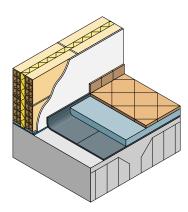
Colocación del pavimento y rodapié en un suelo con capa anti-impacto de polietileno reticulado.
